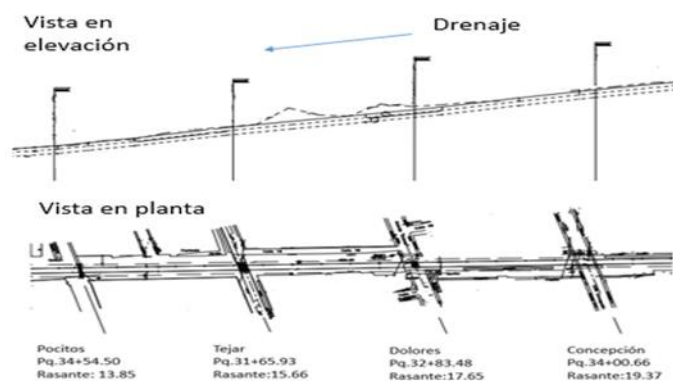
Detalle de la planta y el perfil del primer subtramo. Tomado de [3].
